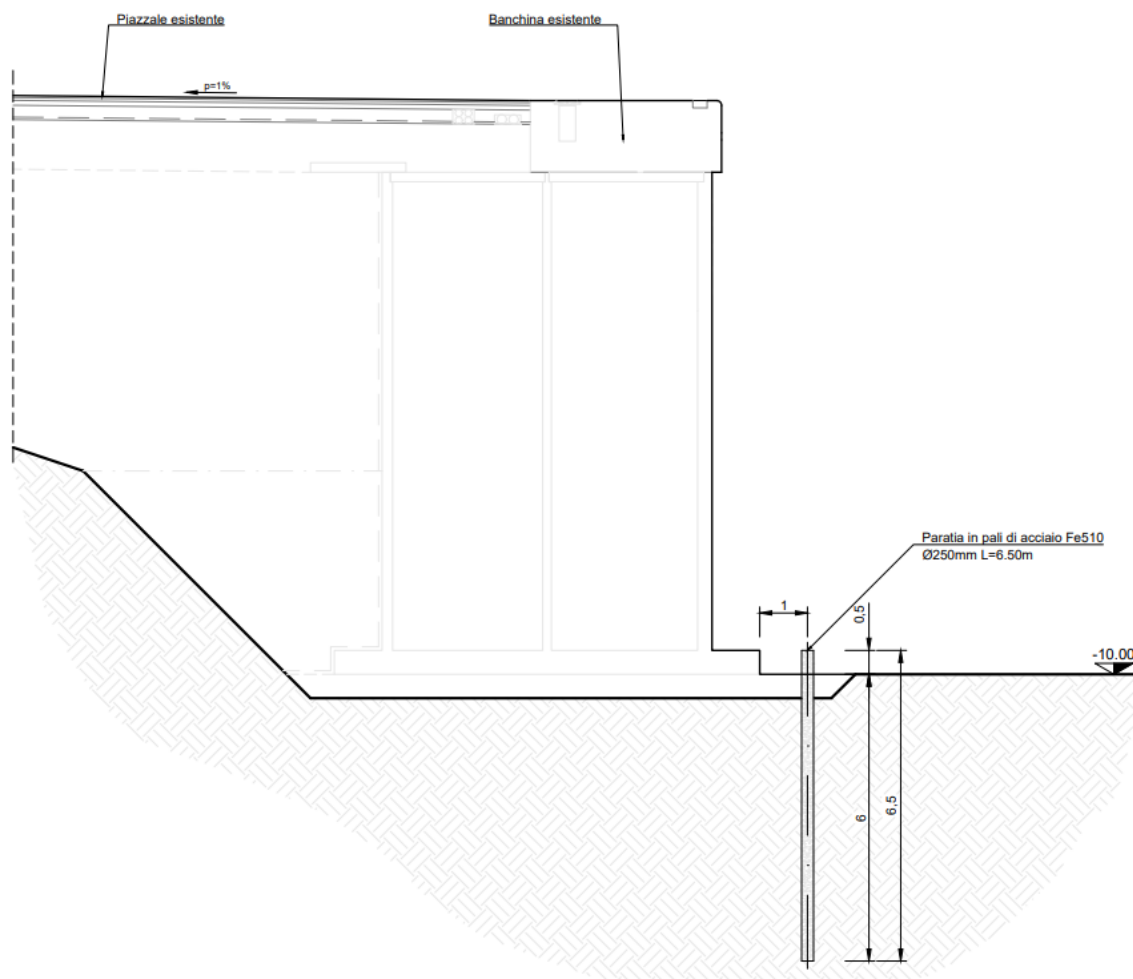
Sezione tipo dell'intervento di consolidamento del piede dei cassoni di Isola Bianca.
